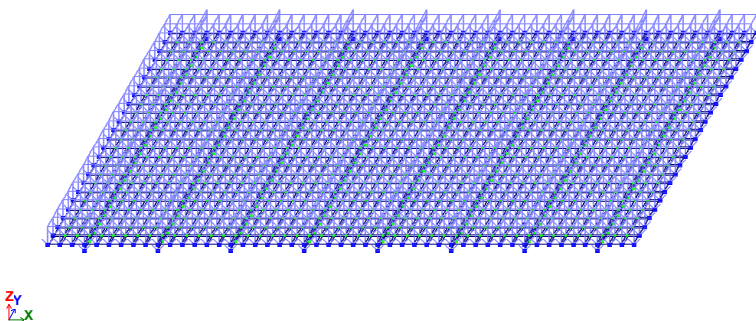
Постоянная нагрузка на плиту перекрытия.
